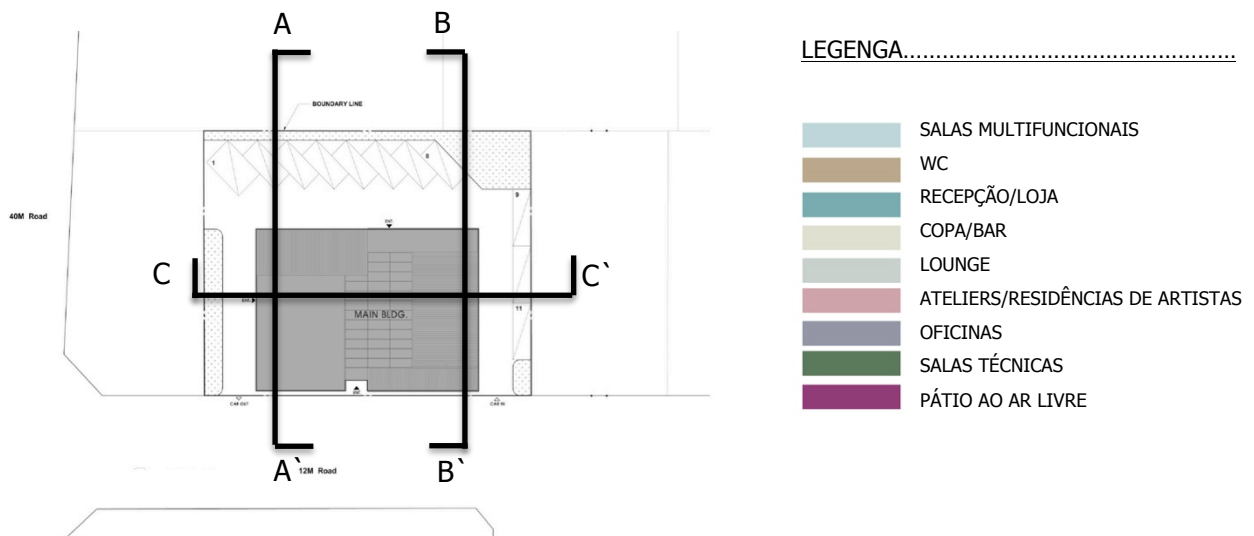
Planta da Corbertura. Platoon Kunsthalle
